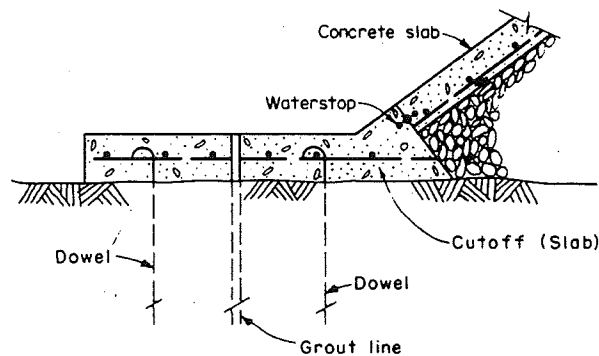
Detail aansluiting asfaltvlies - betonnen kwelscherm bij rotsdam
